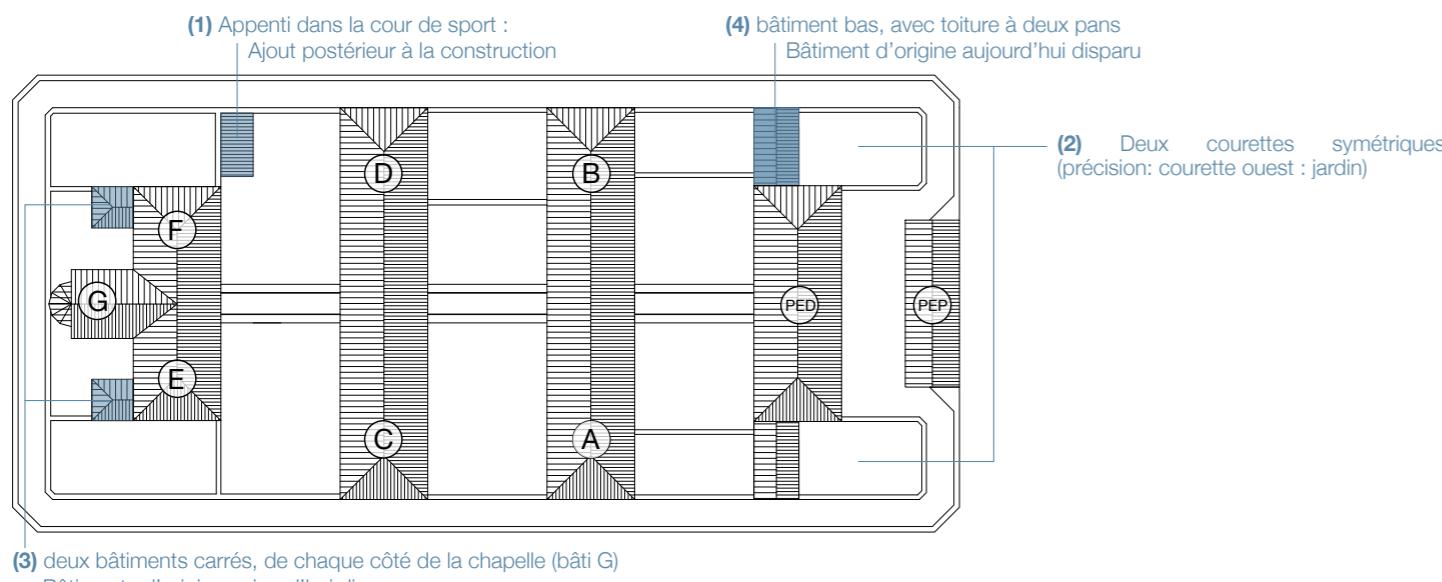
Plan de toiture supposé en 1947, d'après photographie aérienne. Source: Croisée d'archi
